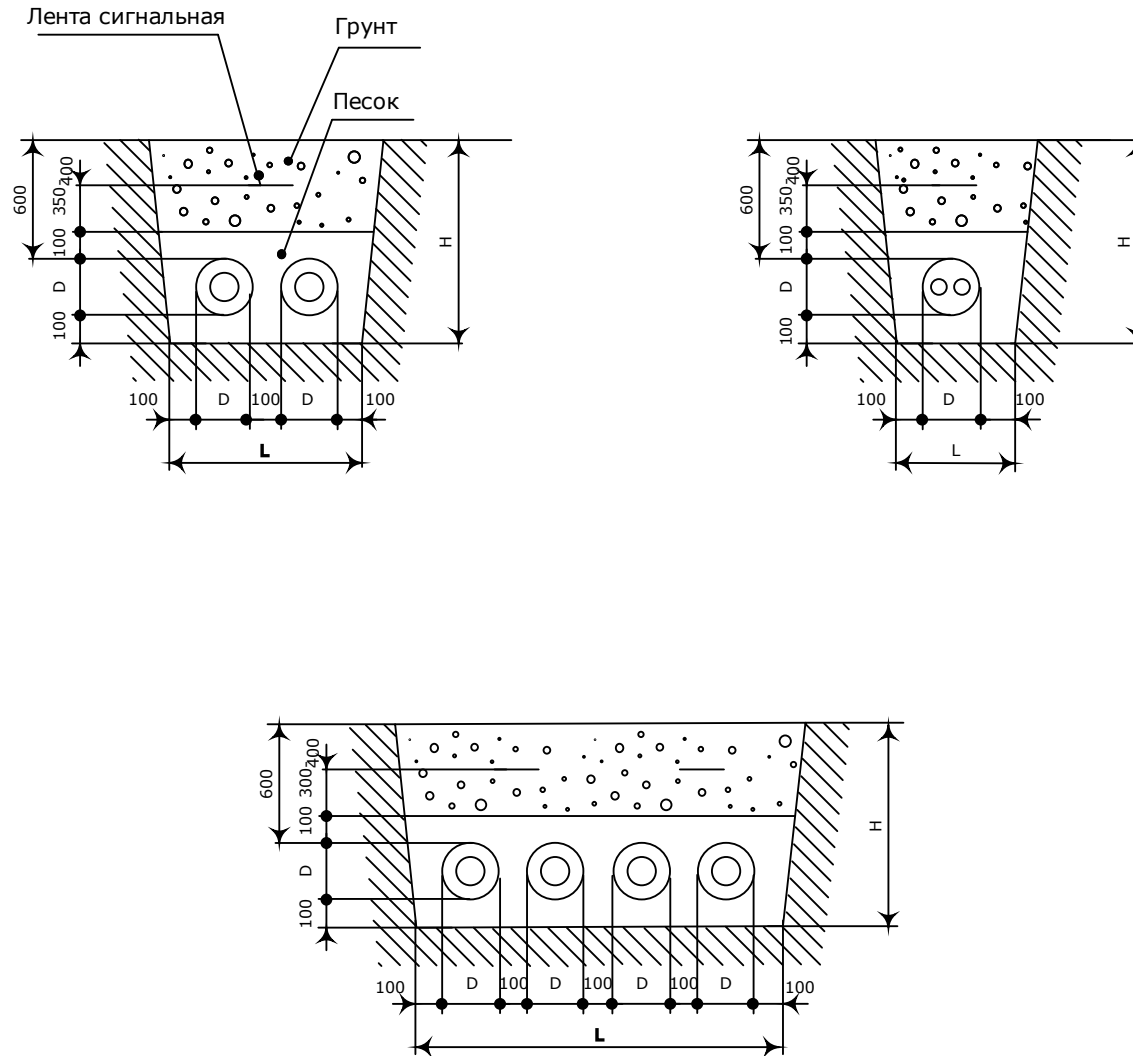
Узлы бесканальной прокладки (п.6.1.3.1, 6.1.3.3 ТКП 45-4.02-184)
